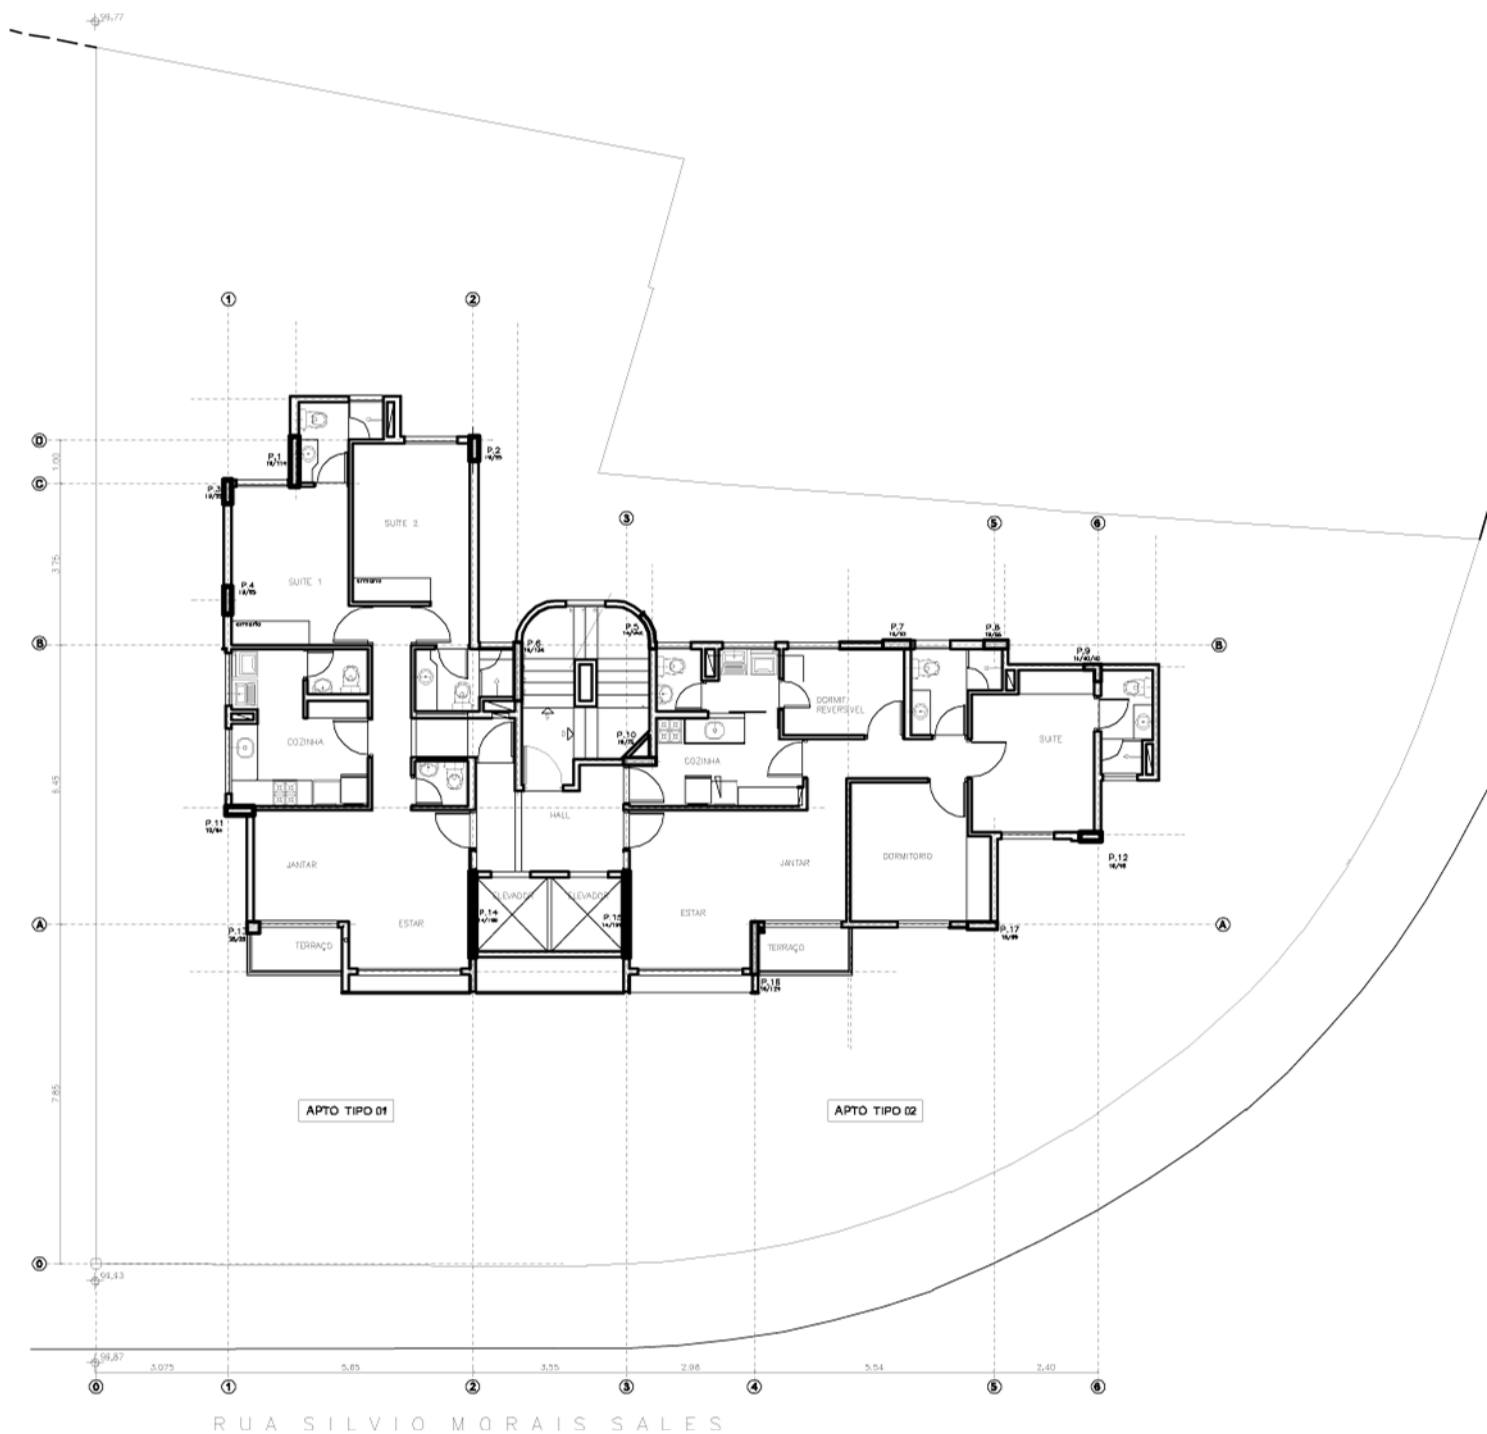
Planta do pavimento tipo do Edifício Rennes. Fonte: Arquivo do autor.
